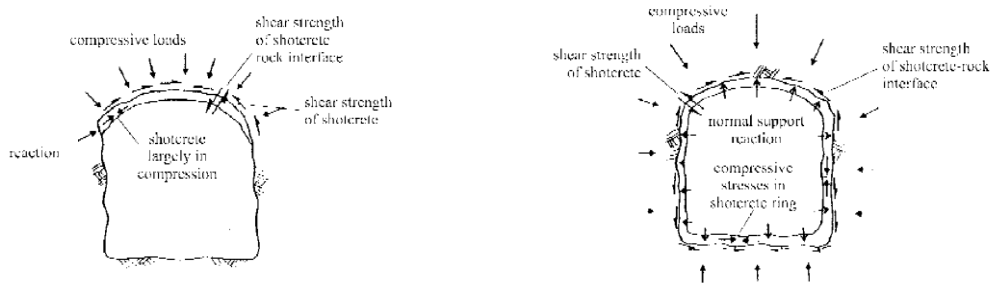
Mecanismos de sostenimiento con concreto lanzado en tunelería (Brady et Al, 2006)
